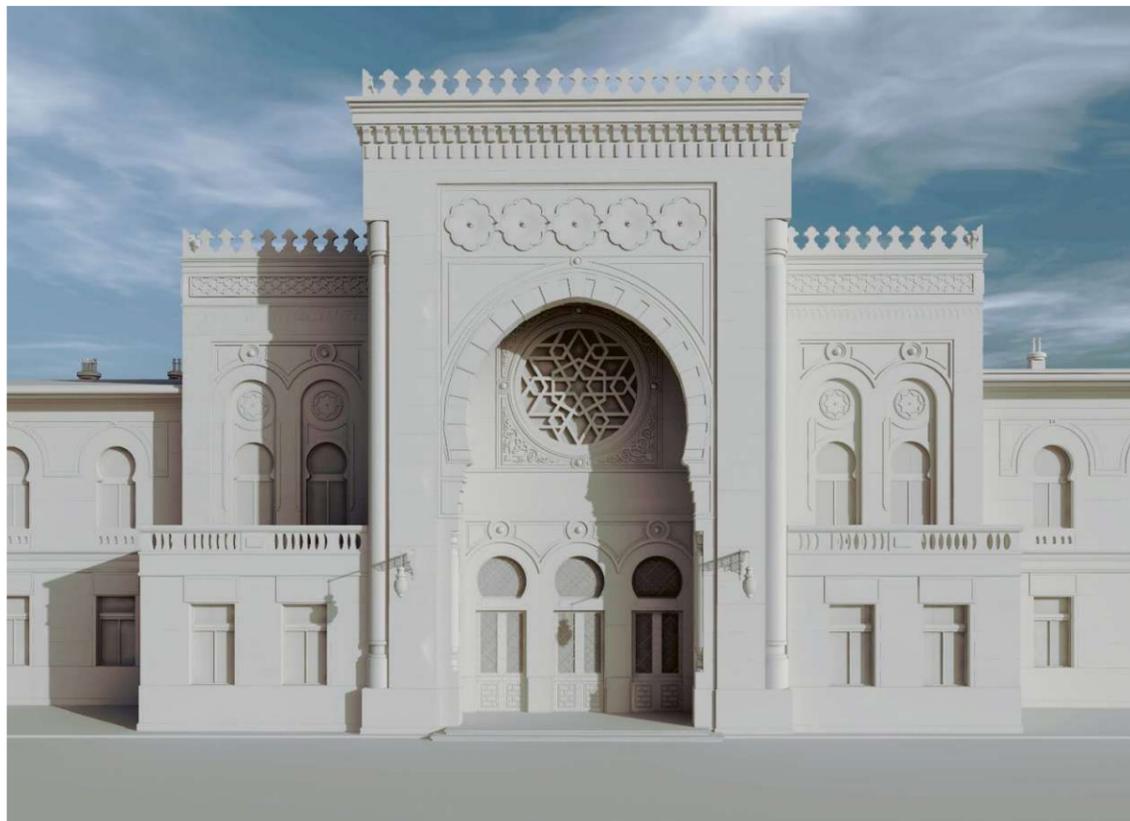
Rekonstruktion Nordfassade Haupteingang, straßenseits, Weißrendering
